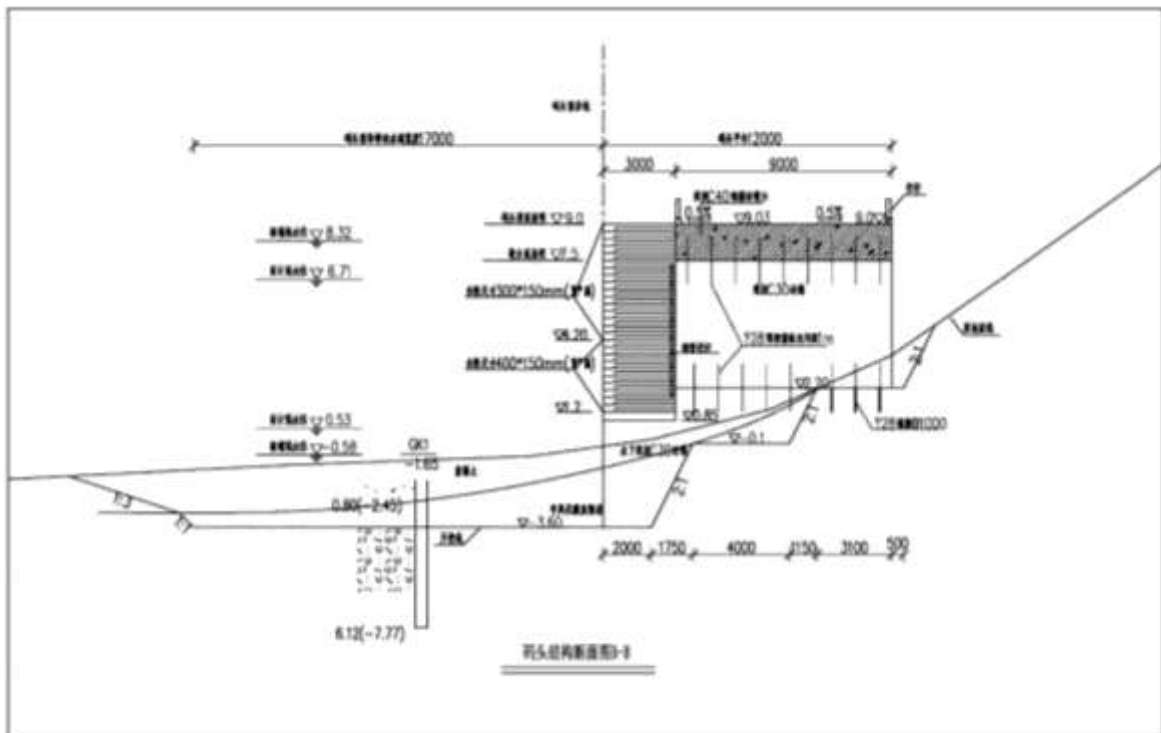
连江下宫松皋陆岛交通码头 B-B 断面图
